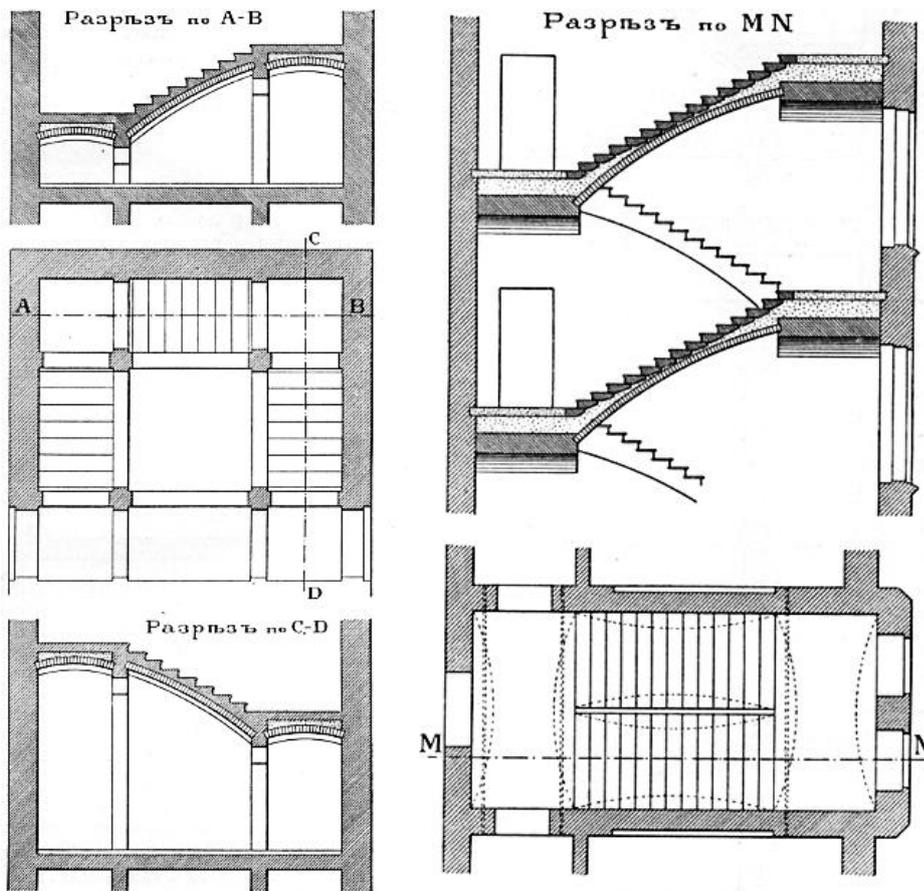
Лестницы на сводах. В.Р. Бернгард, 1903 г. [7]
